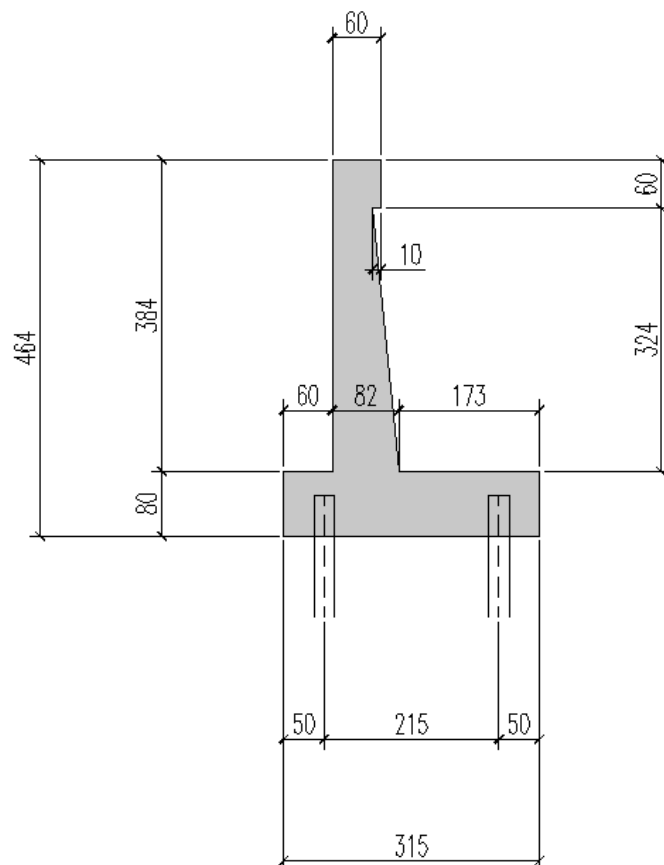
Carpenteria Sezione ad altezza maggiore del Muro M03
